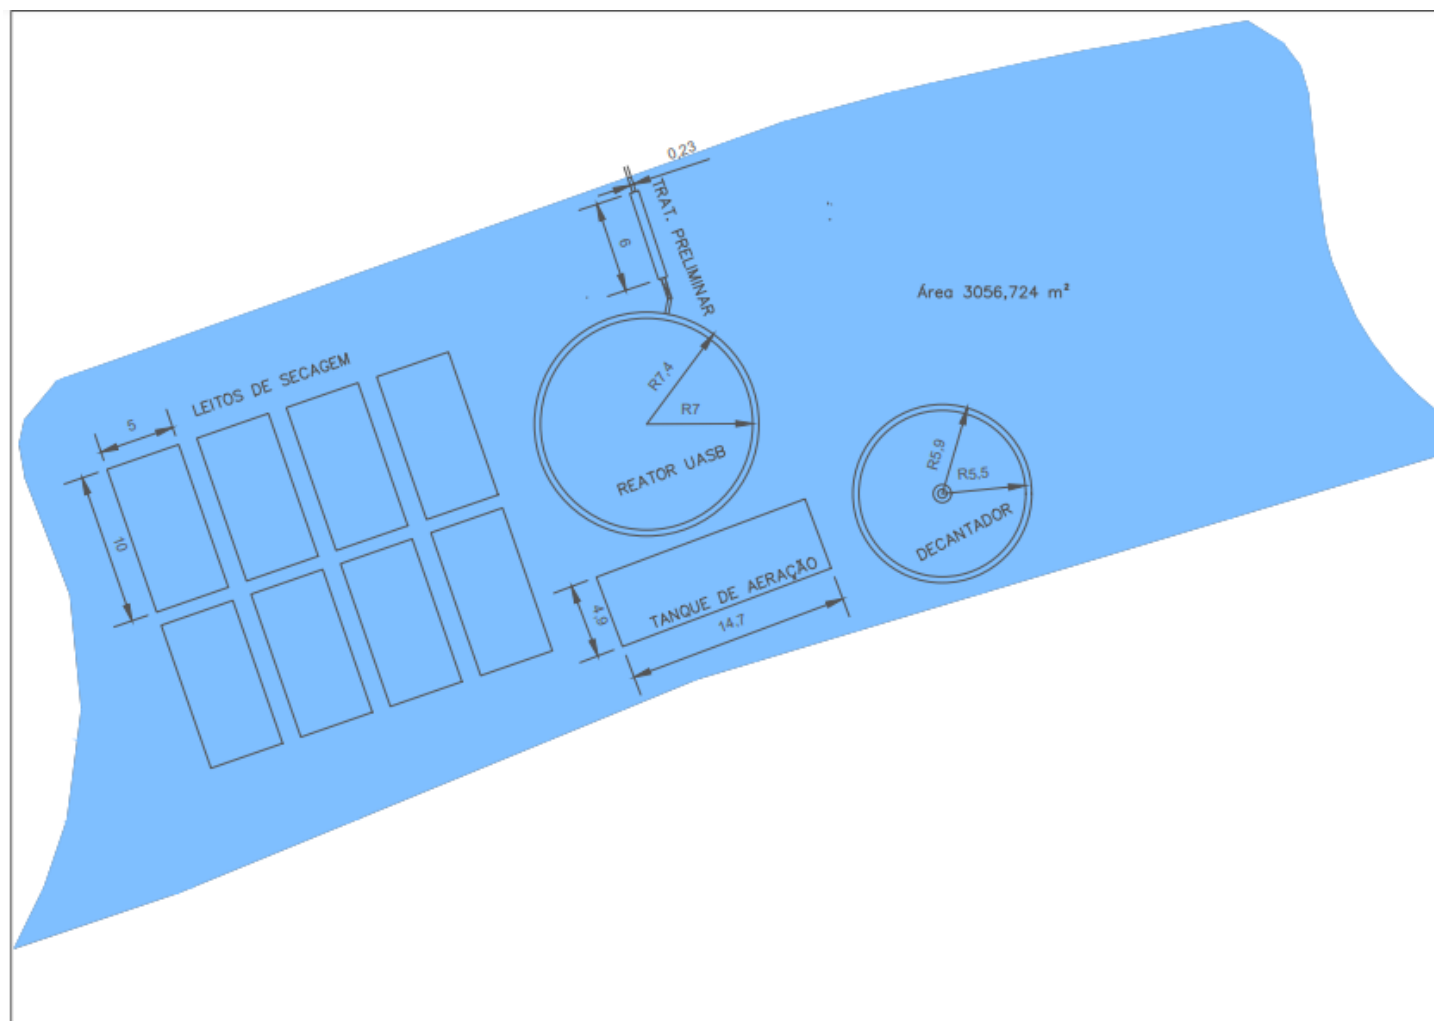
Planta esquemática das concepções para a ETE na área institucional de projeto.
